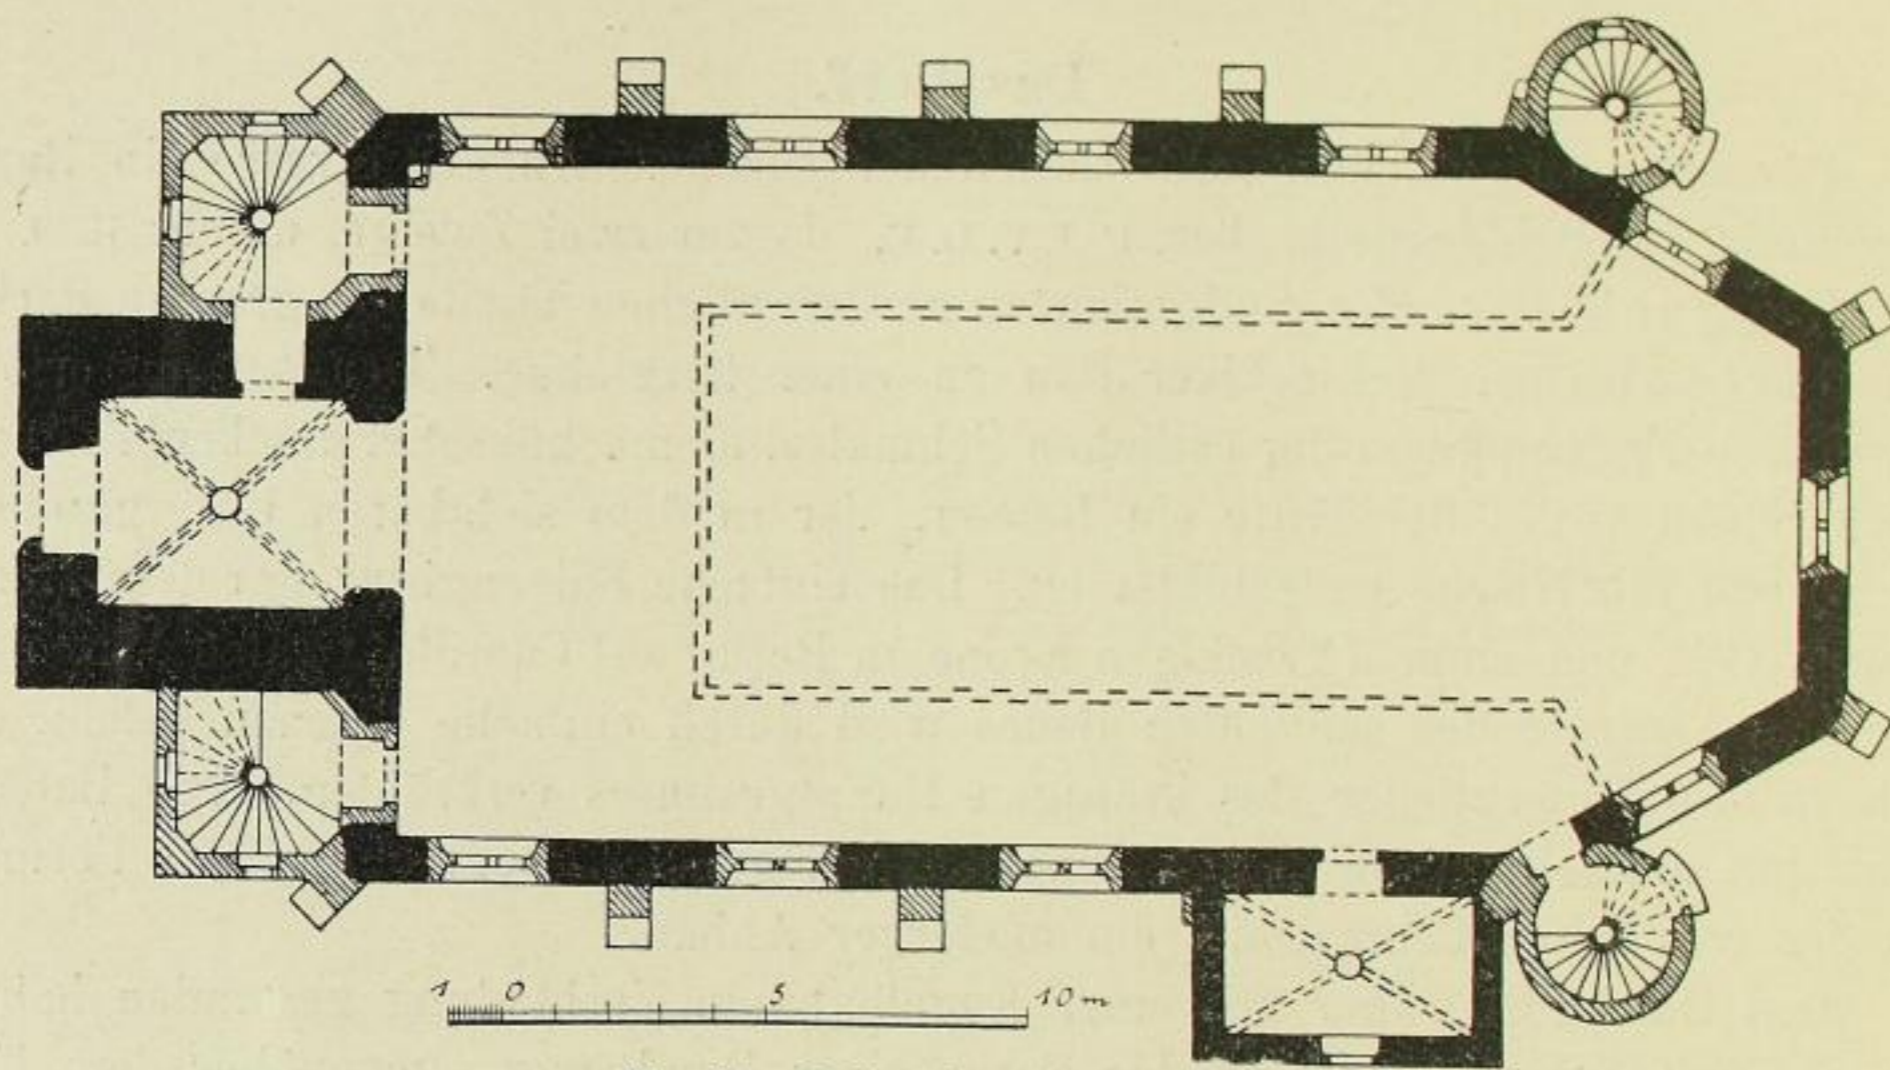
Kaditz, Grundriss der Kirche.
